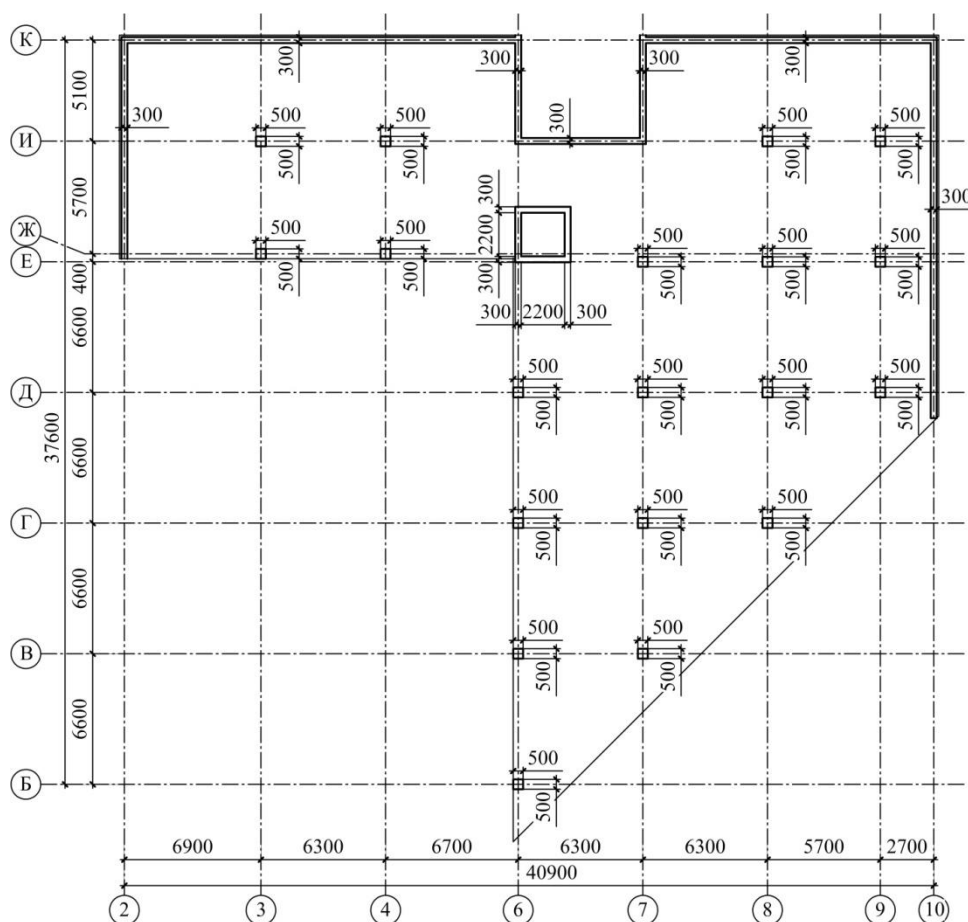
План здания с введенными монолитными железобетонными стенами
